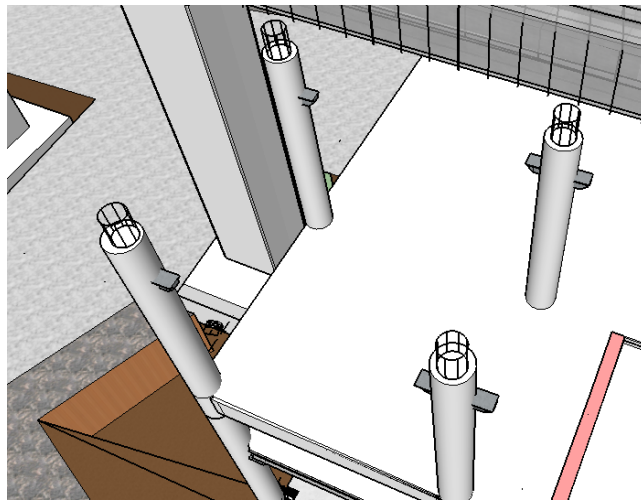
Render de columnas en losa intermedia de Vestíbulo
